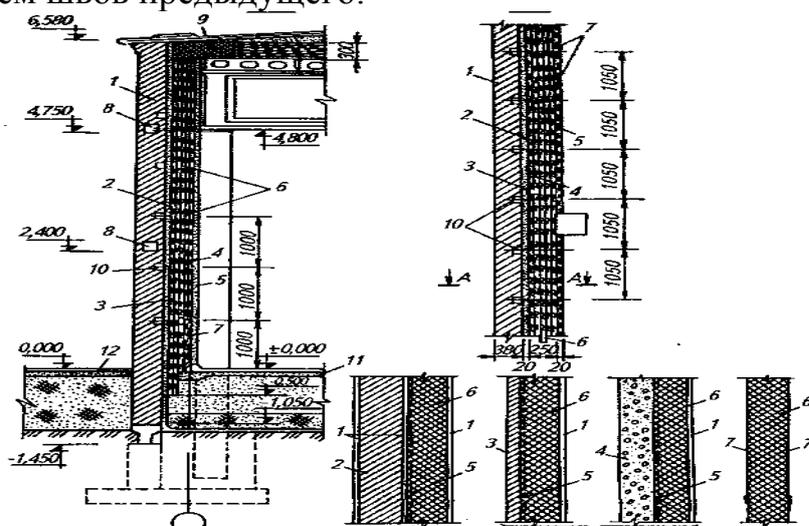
Изоляция наружных кирпичных стен одноэтажного холодильника:
